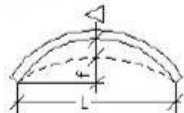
Montážní tolerance sloupů jednopodlažních budov
